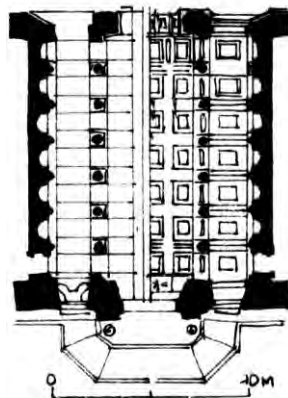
Палаццо Фарнезе. План главного входа и фрагмент фасада
